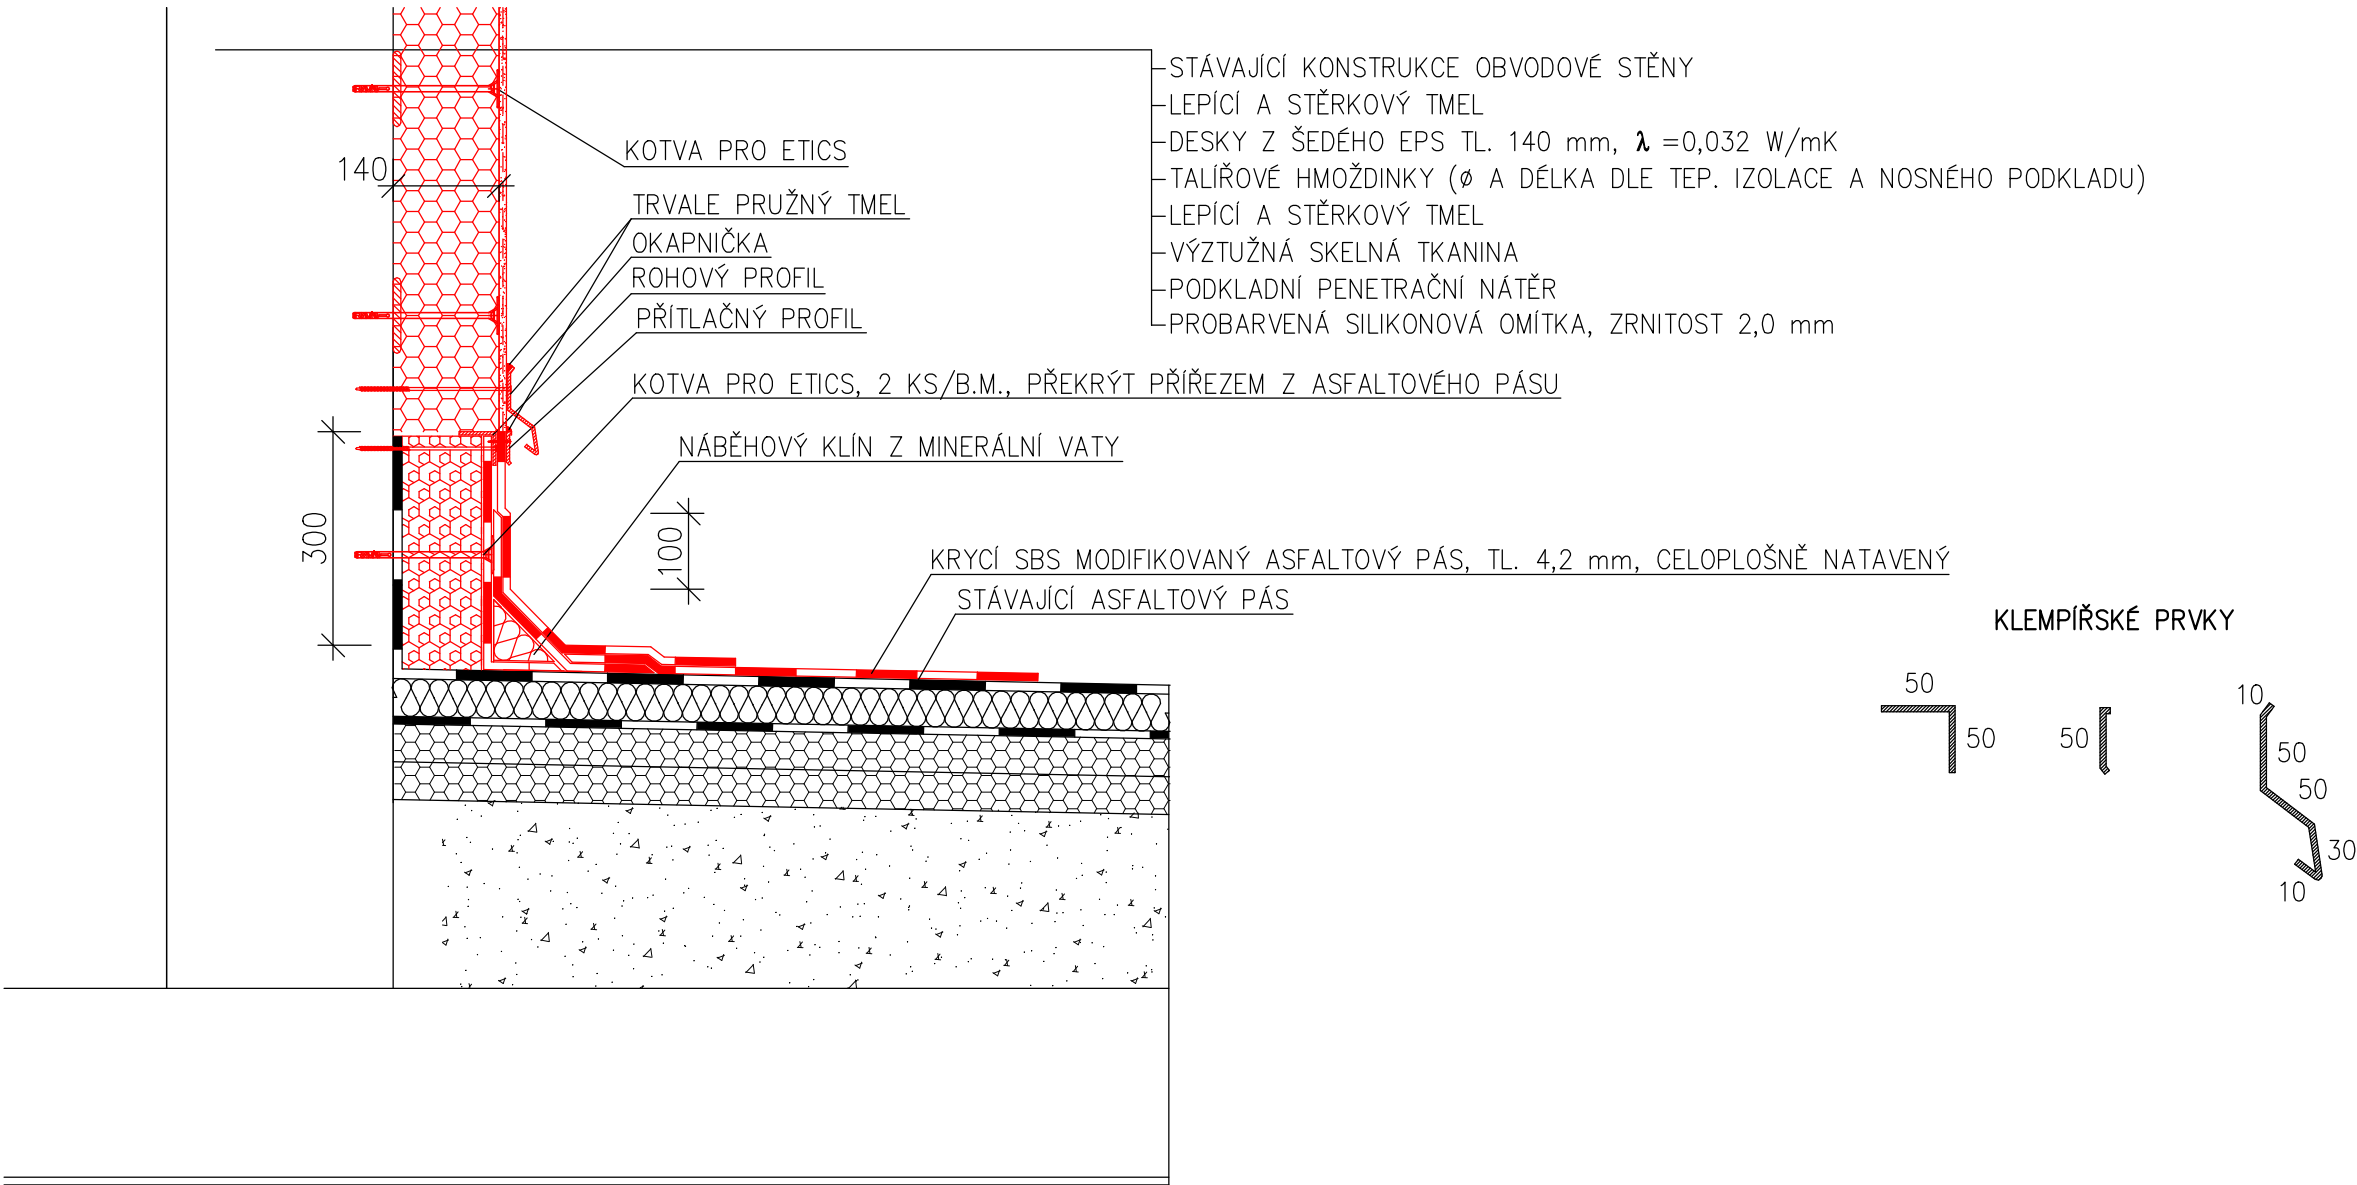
DETAIL F – ÚPRAVA OPLECHOVÁNÍ ATIKY 1:10
